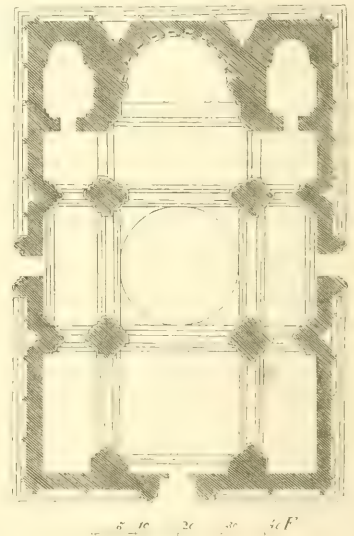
Kathedrale zu Ani (Grundriss).
